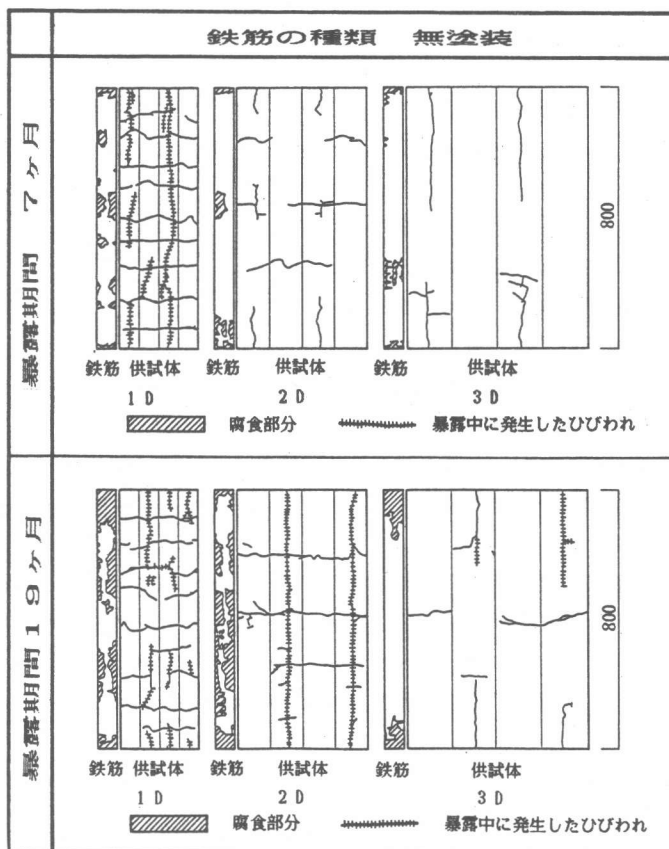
供試体のひびわれ状況と鉄筋の腐食状況
